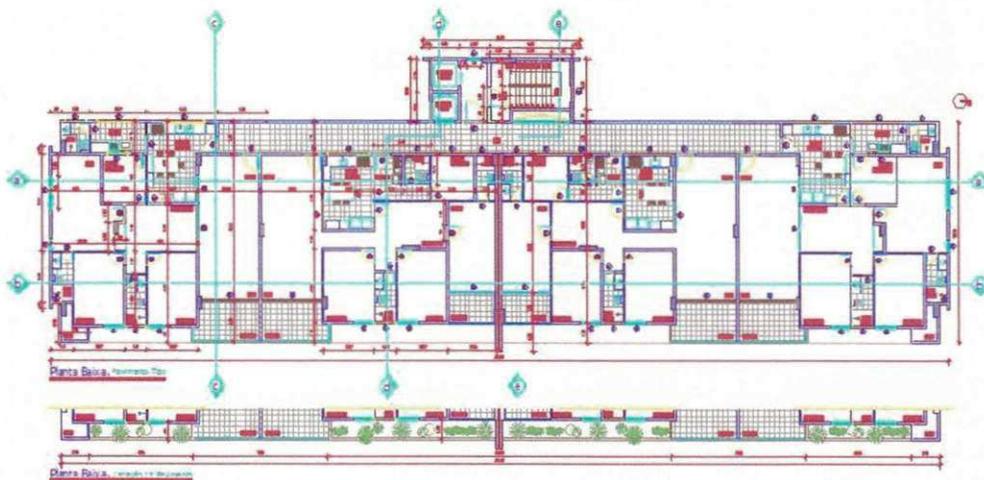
Planta baixa do pavimento tipo do Edifício residencial Portal da Serra.
